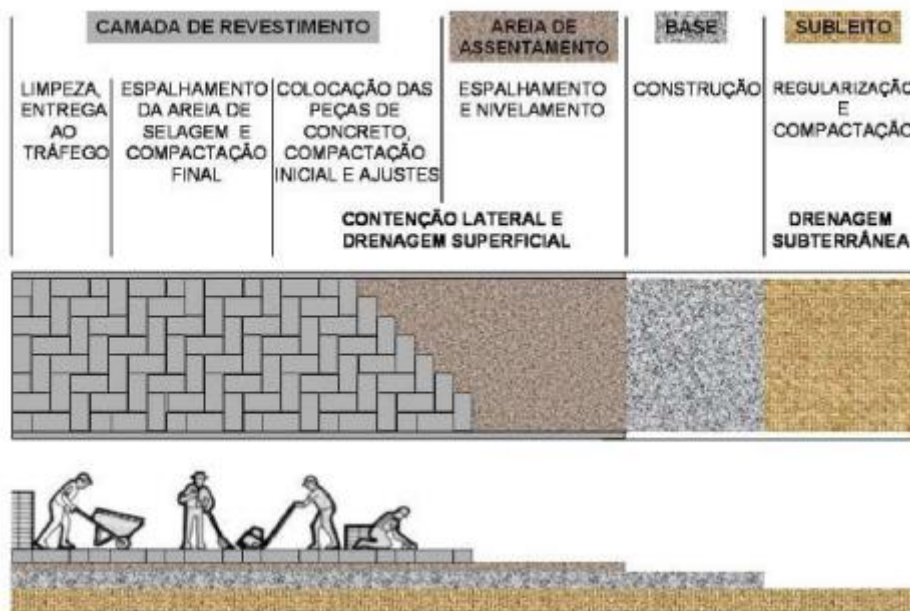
Processo construtivo de pavimento intertravado (MADRID, 1986).
